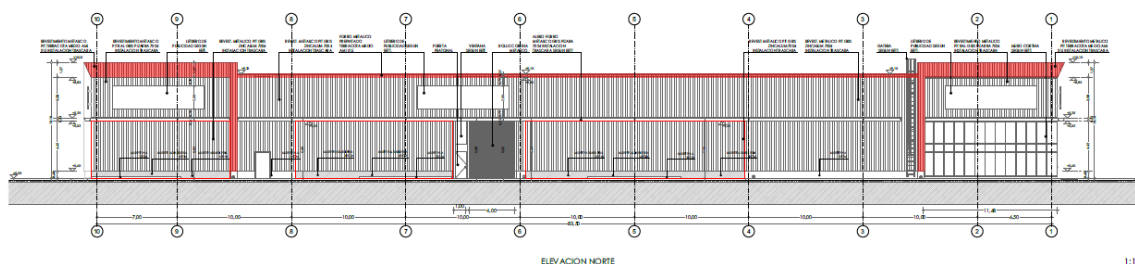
Elevación de arquitectura (fachada norte) de la Nave F: envoltente metálica continua.
